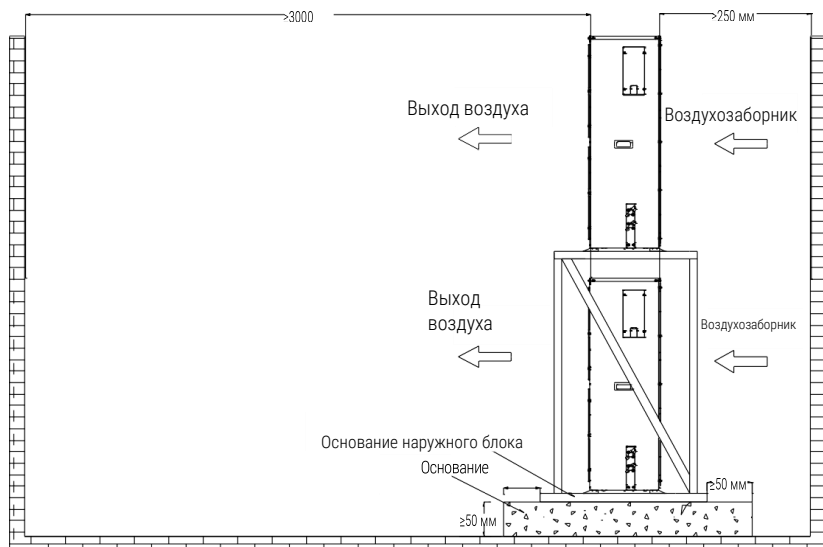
Схематический набросок установки наружного блока внахлест
